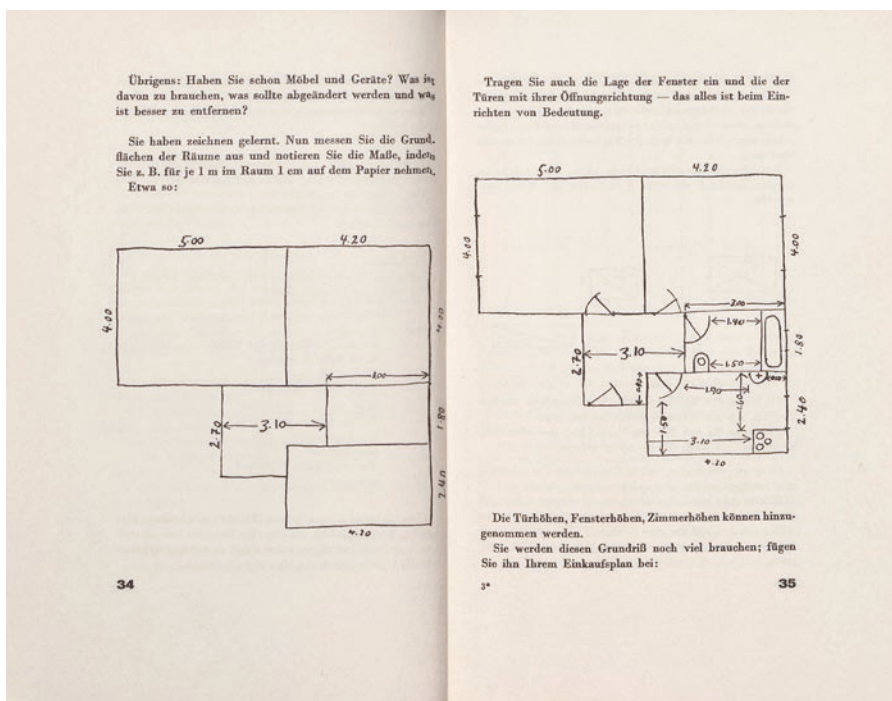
Anleitung zum Grundrisszeichnen in ZWECKMÄSSIGES WOHNEN für jedes Einkommen.
